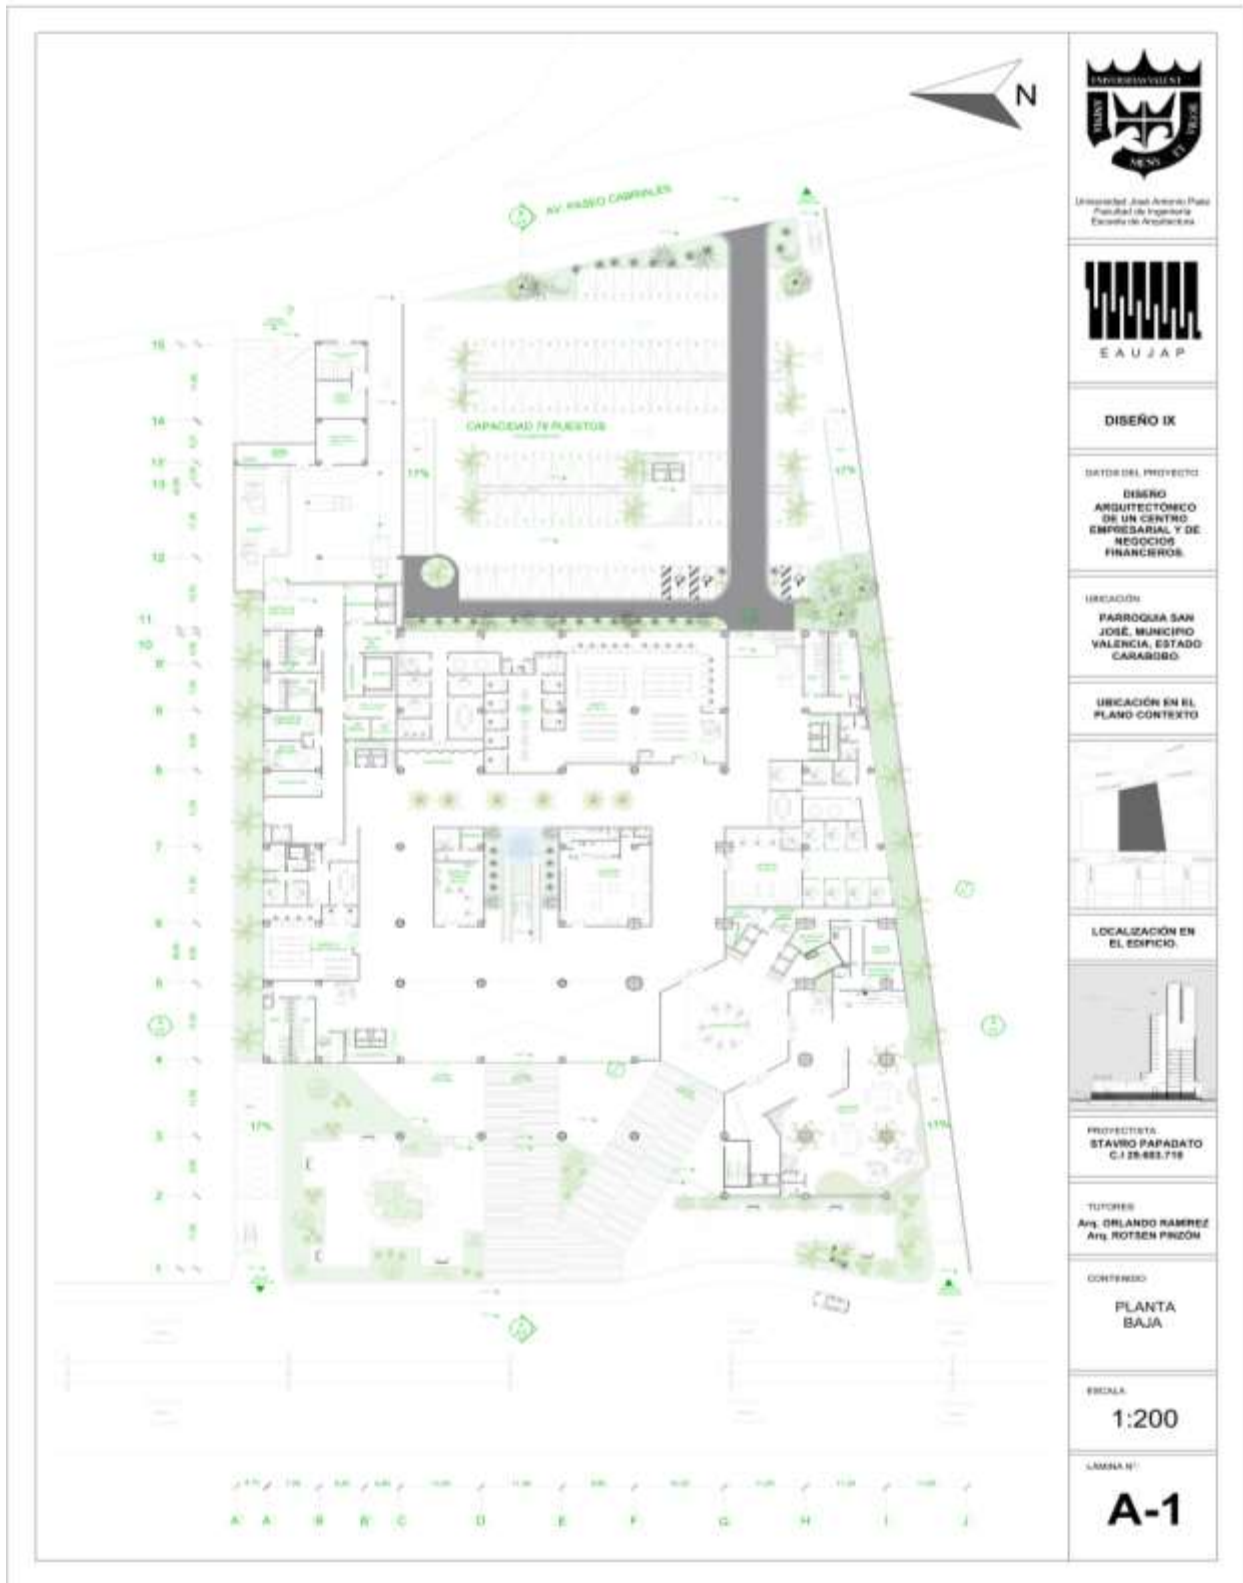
A-1 Planta Baja Fuente: El Autor (2023)
